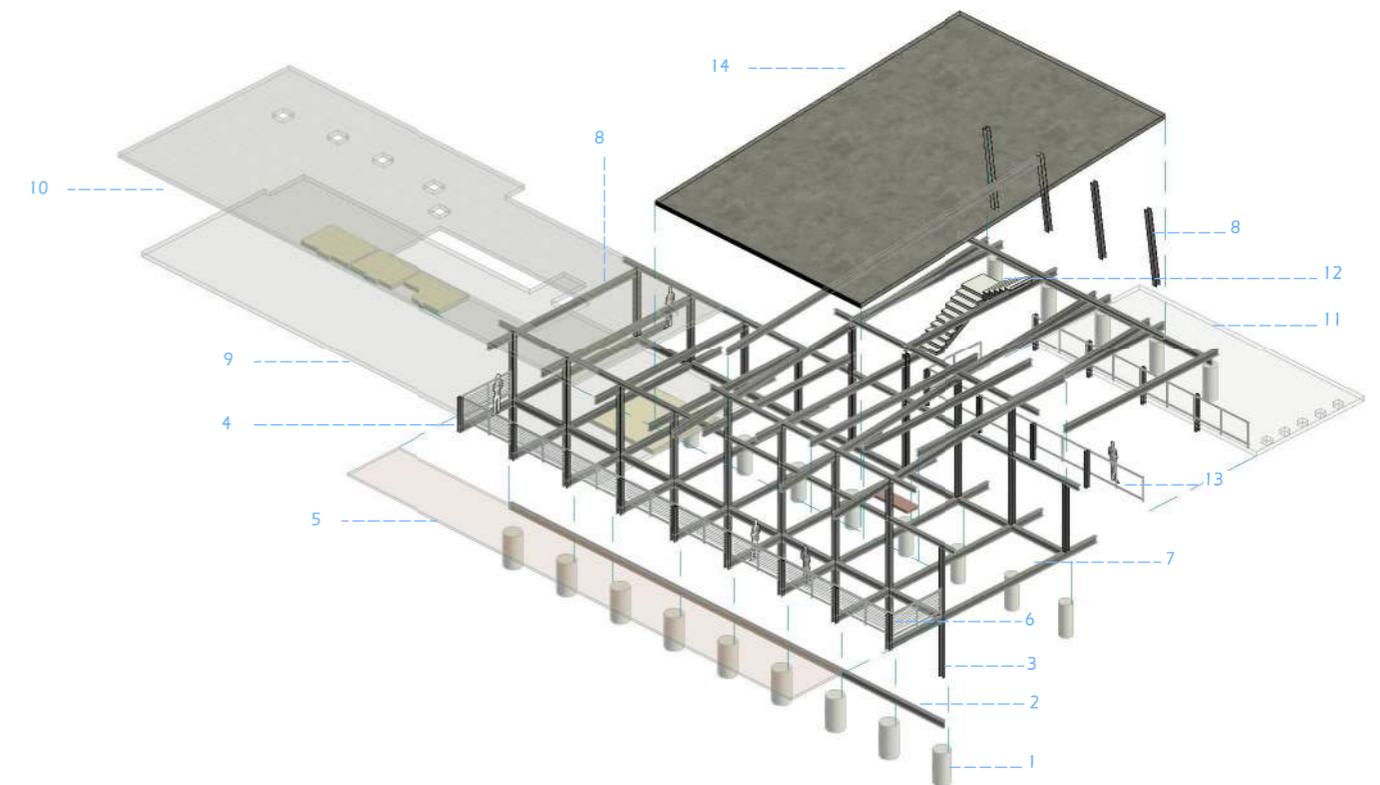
Plano de detalle de estructura aporticada, publicado en la pagina de instagram Case Study House 26. Muestra la modulación del marco estructural y la utilización sistematica.
